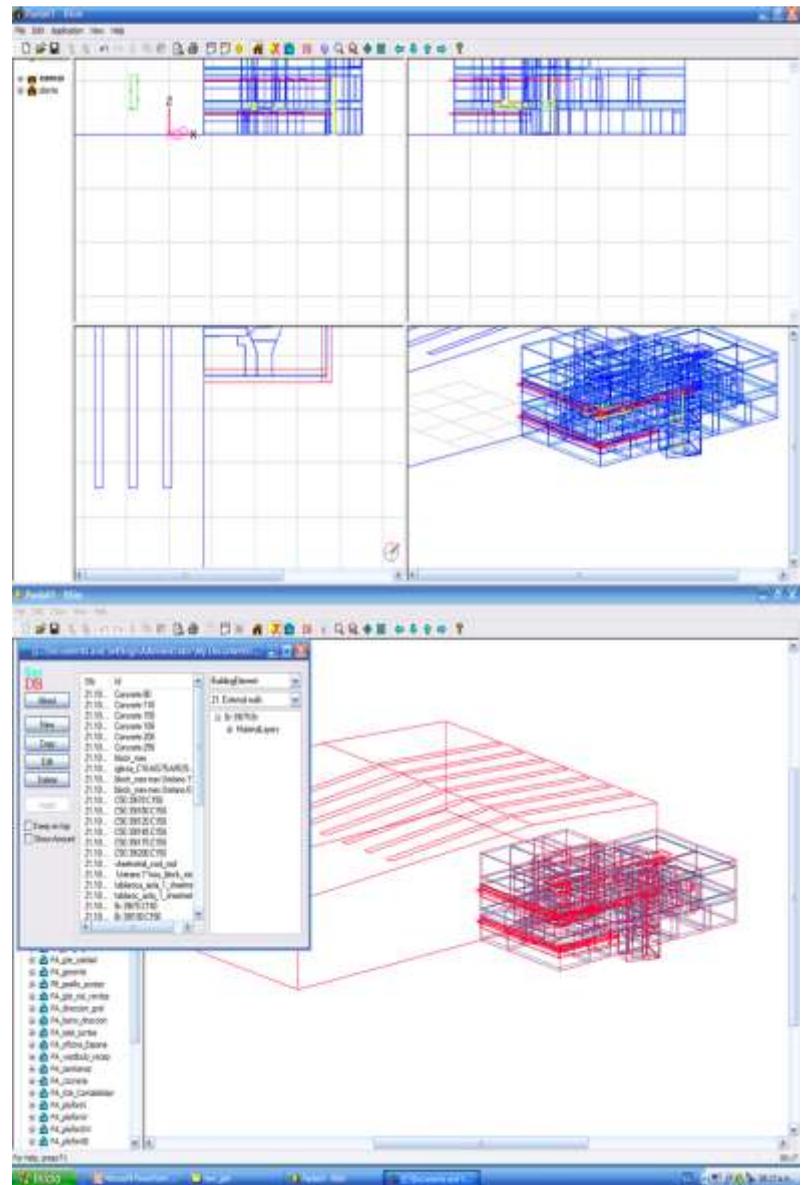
Este gráfico muestra la geometría total del edificio, las secciones en planta y alzados para tener un mayor dominio de la volumetría. Así mismo se puede observar al proyecto entero, el edificio de oficinas en conjunto con la nave industrial, llevada a cabo volumétricamente para evitar variaciones en las condicionantes del proyecto y su análisis.
